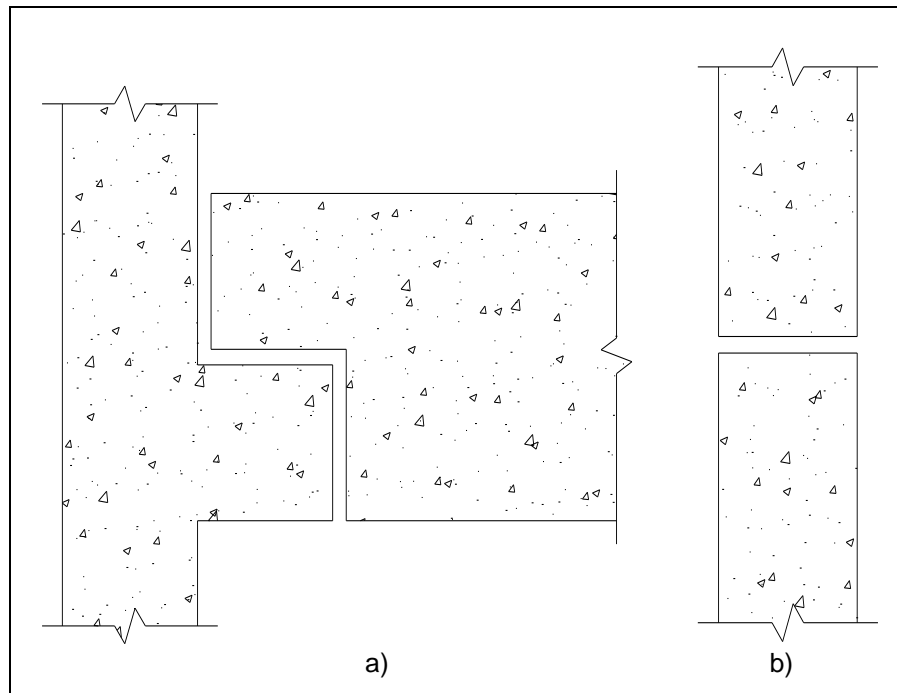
Ligação: a) Viga-pilar; b) Pilar-pilar
